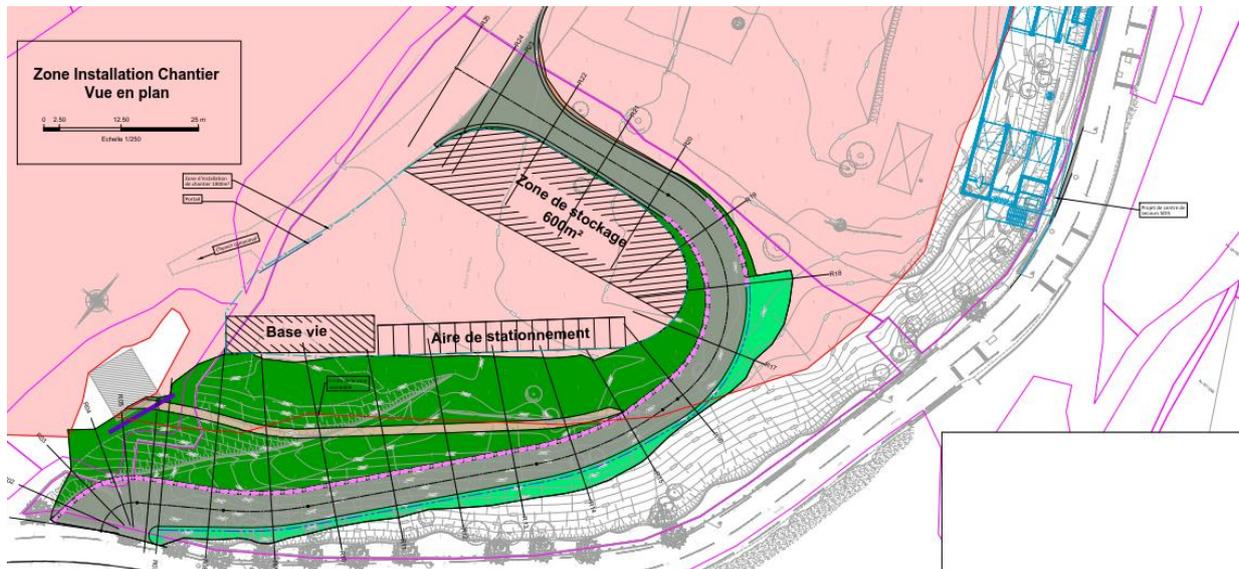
Plan d'installation de chantier sur la parcelle 0474
